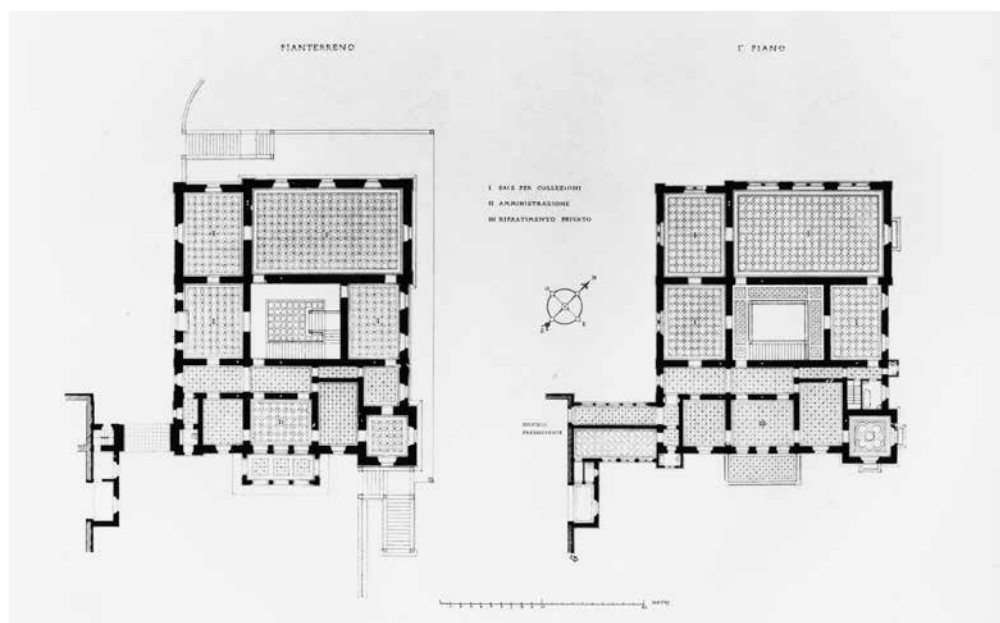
Pianta del piano terra e del primo piano (terza variante)
